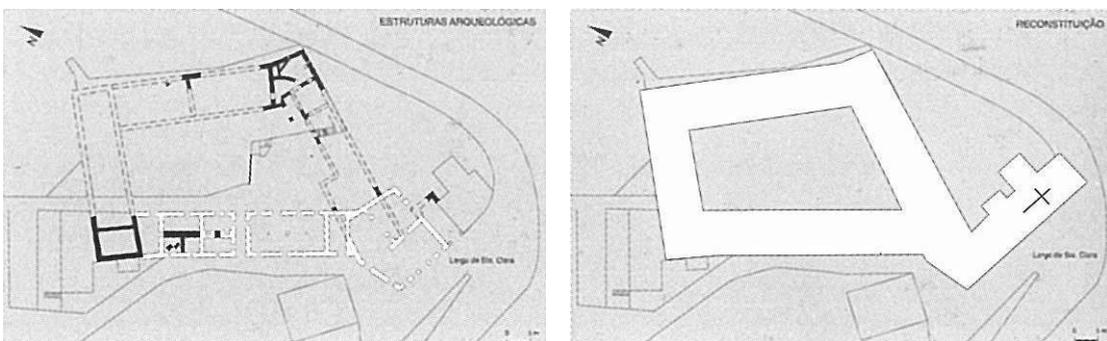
Estrutura arqueológica e reconstituição da planta do convento
